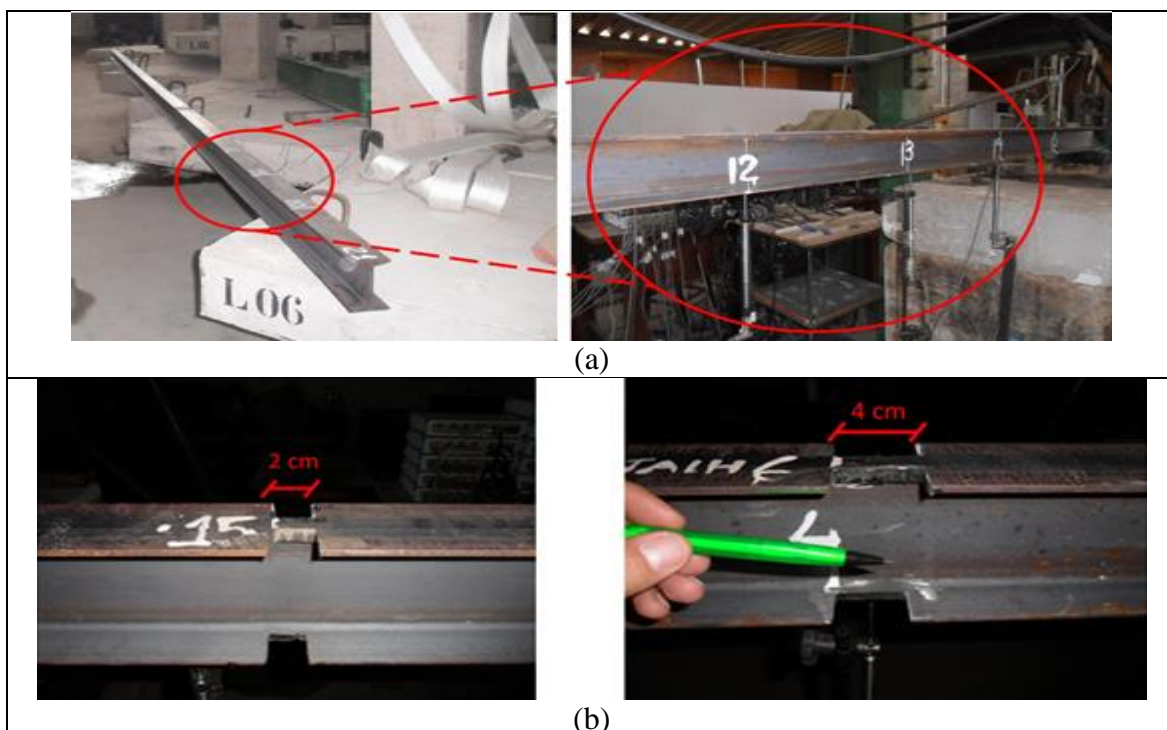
Panorama das vigas: (a) demonstração da viga em 16 elementos e (b) danos induzidos de 2 cm e 4 cm (Palechor, 2013)
